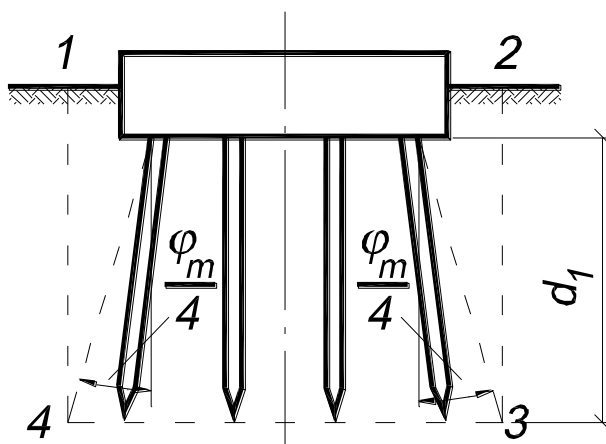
Схема до розрахунків пальового фундаменту як умовно масивного
